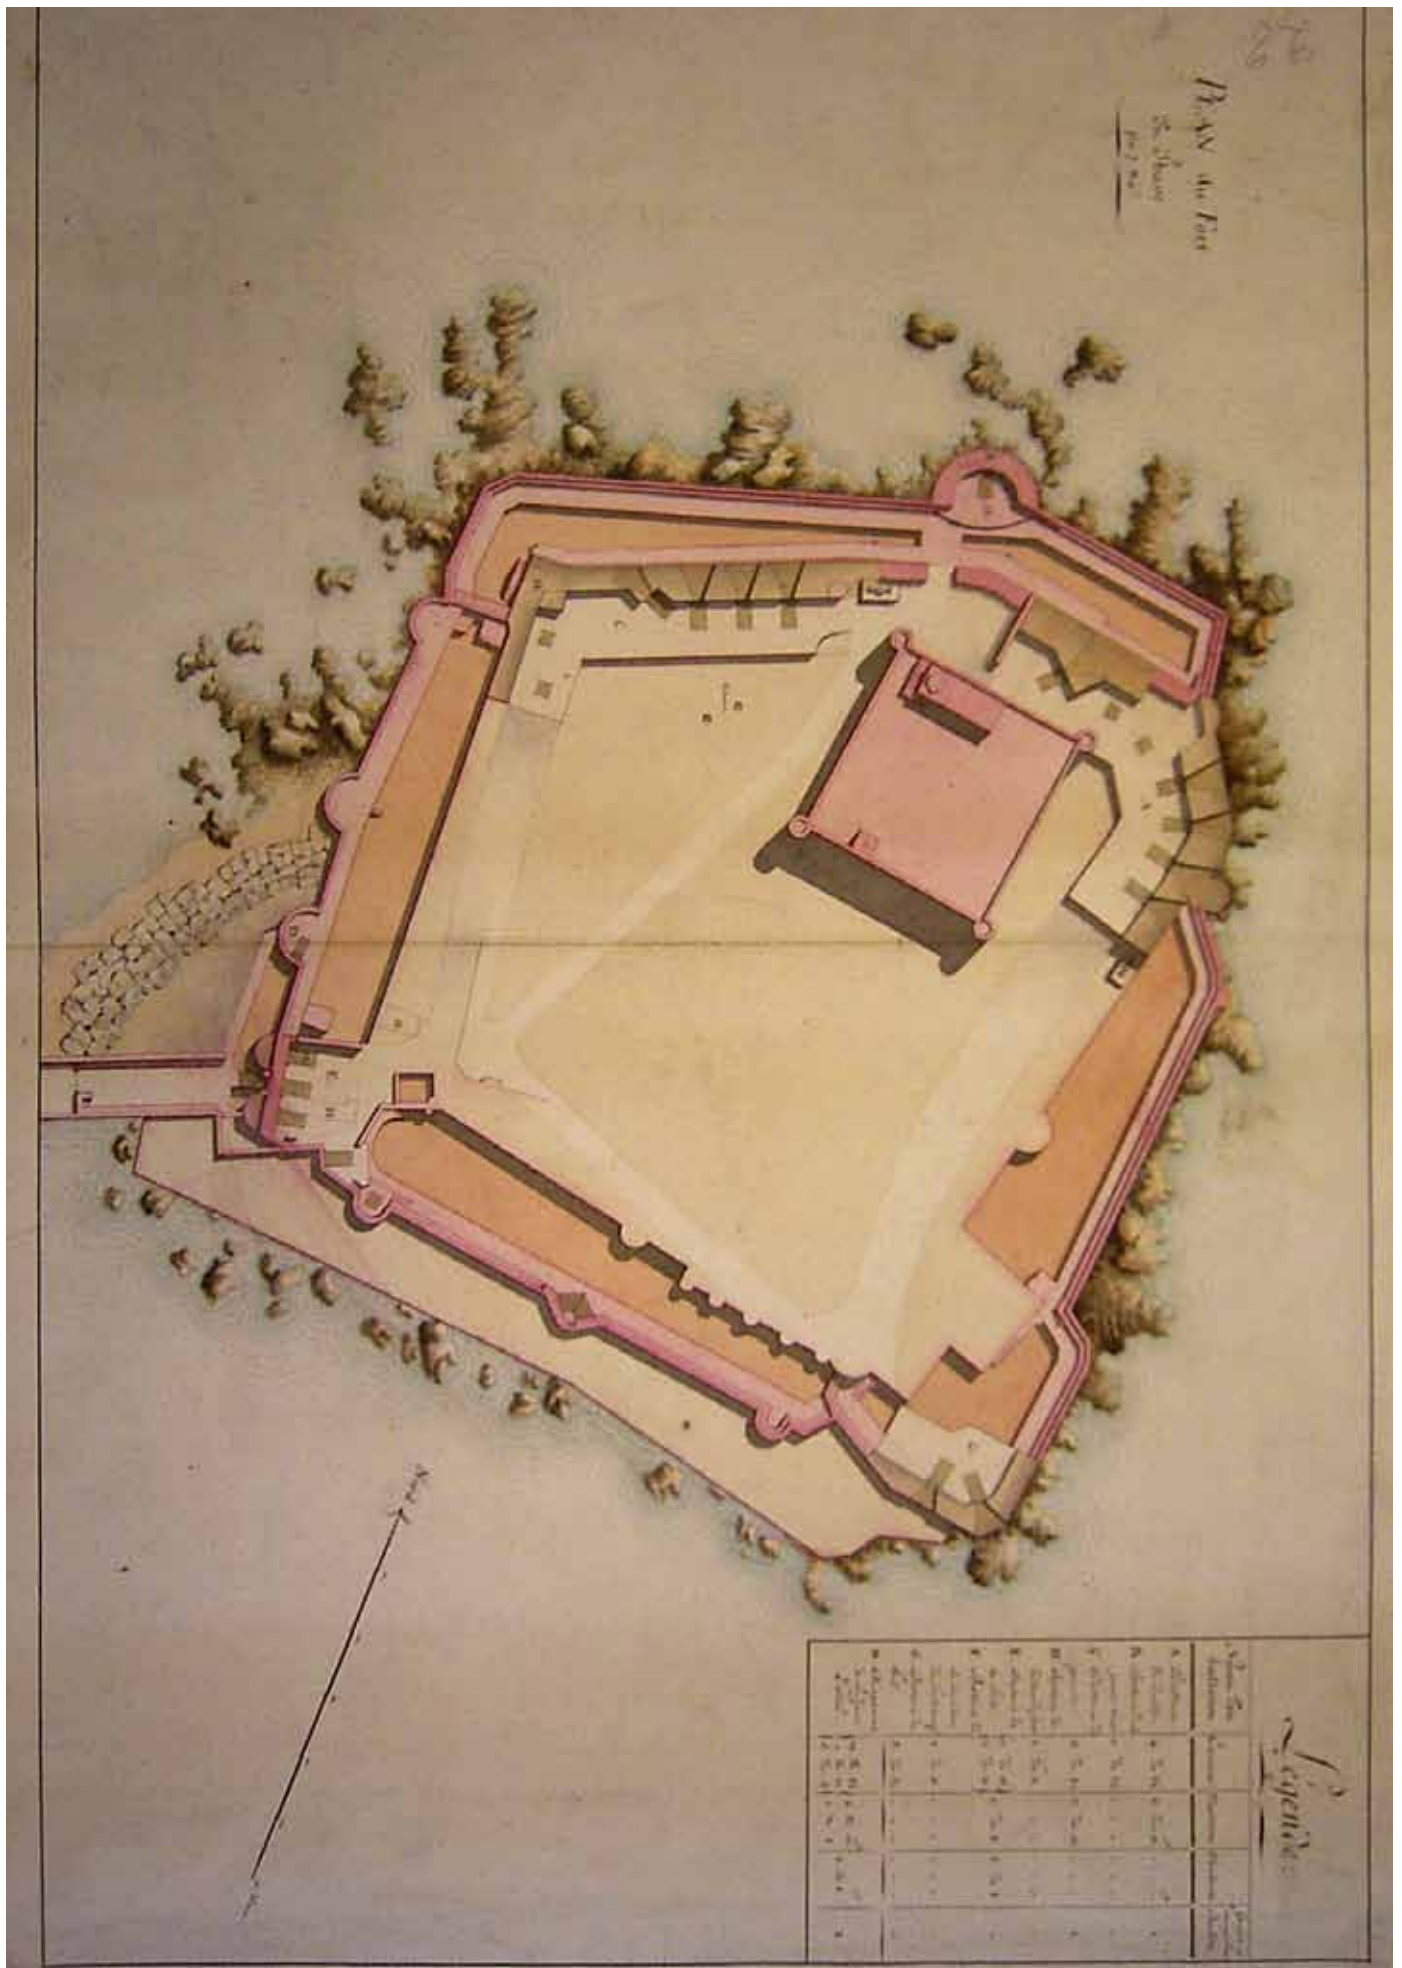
Lageplan: Armée d'Orient, 1801 (SHAT - L II 23, Nr. 20).
